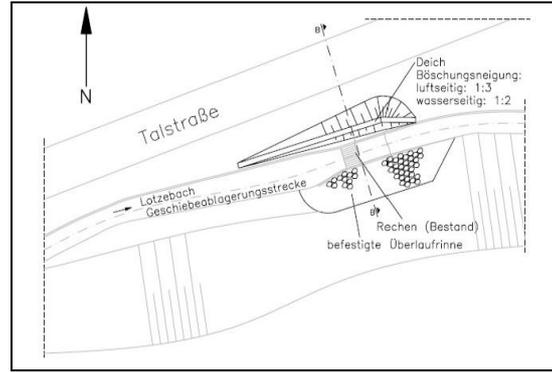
Lageplan Errichtung Schutzdamm und seitliche Überlaufstrecke am Treibgut-/Geschiebefang Lotzebach, 25.10.2018
